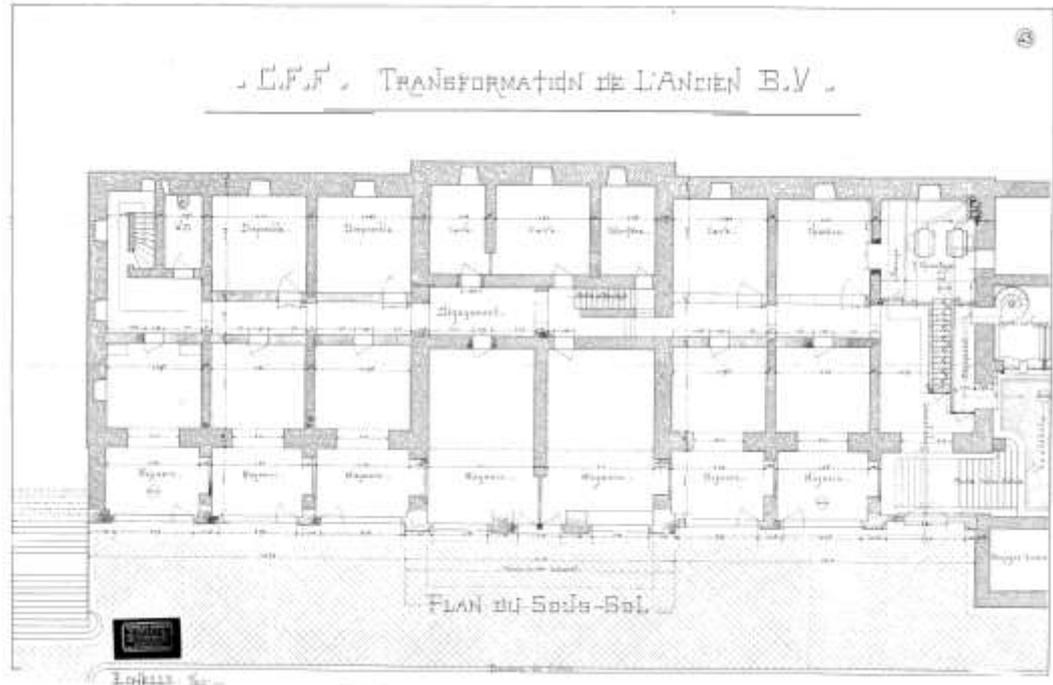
Première gare de Vevey, 1861, Jean Fernel architecte, plan du sous-sol (Georges Coigny, 10.8.1909, CFF Immobilier, SBB-IM-WEST 18000/101).
